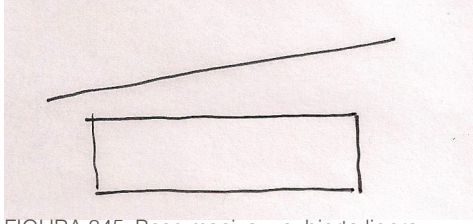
Base maciza y cubierta ligera. Elaboración propia
